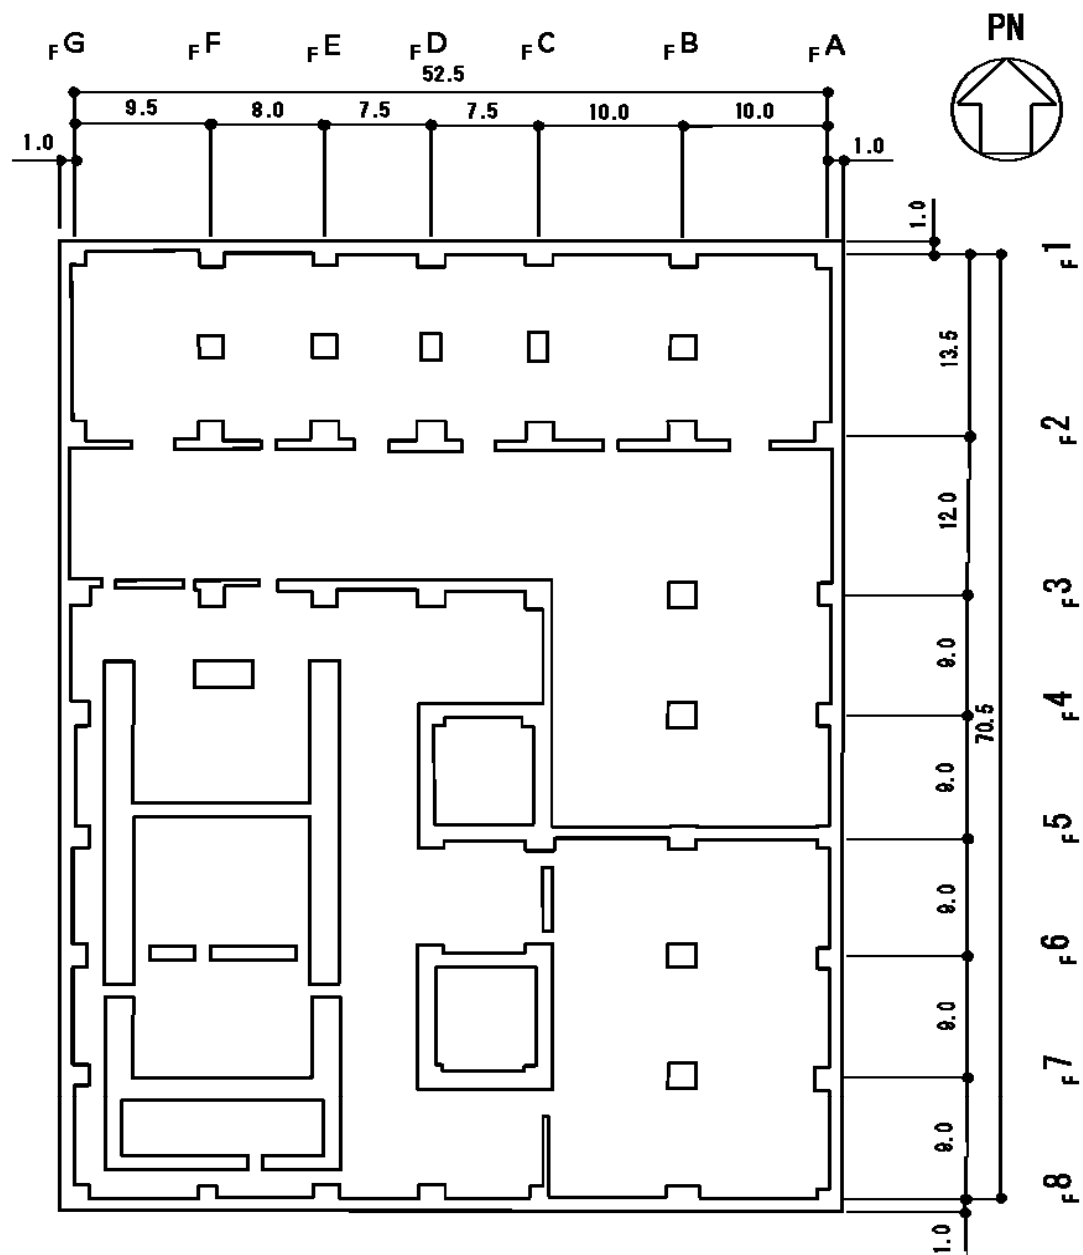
PL/B 基礎版レベル平面図(0. P. 2. 7m) (単位 : m)
